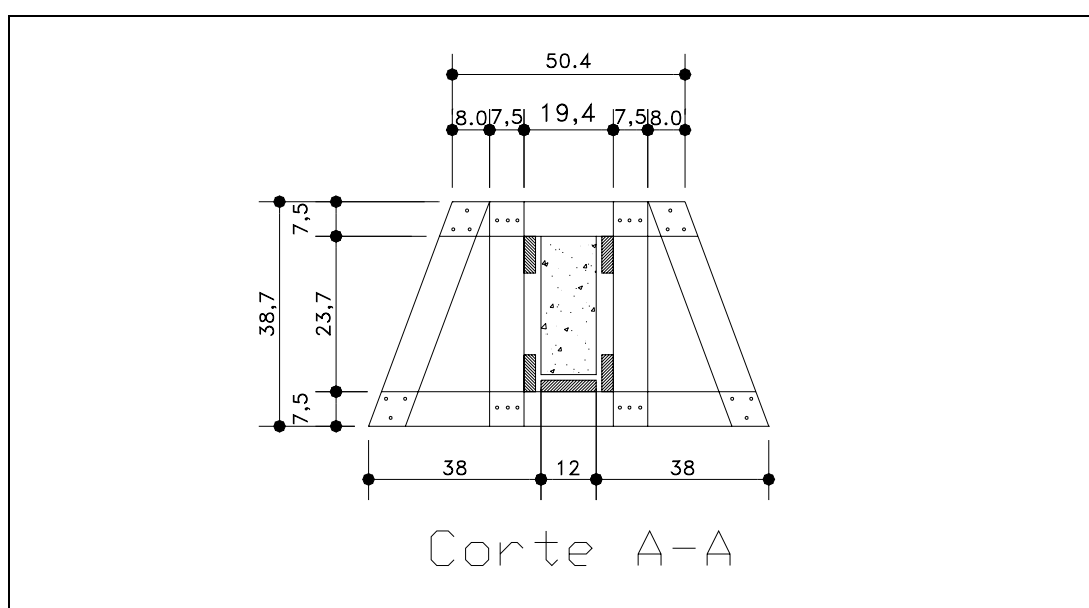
DETALHAMENTO DAS FORMAS DAS VIGAS – VISTA LATERAL
